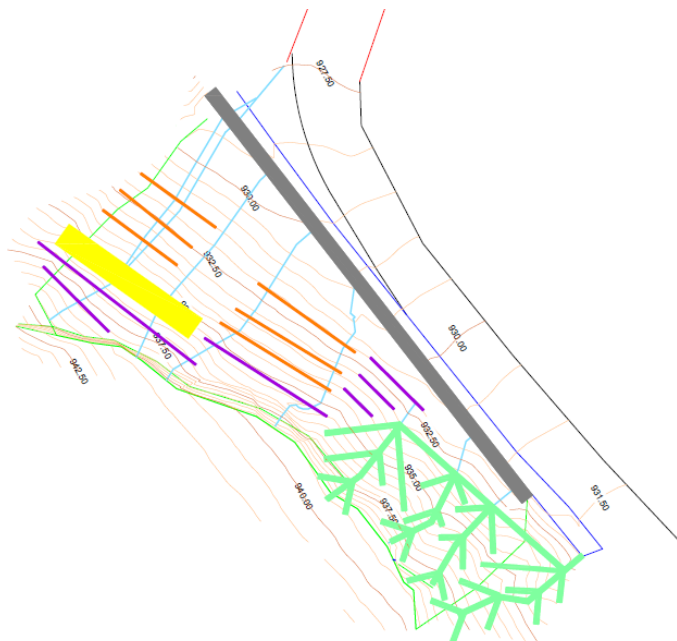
Planta de la Propuesta 2. Fuente: Elaboración propia
